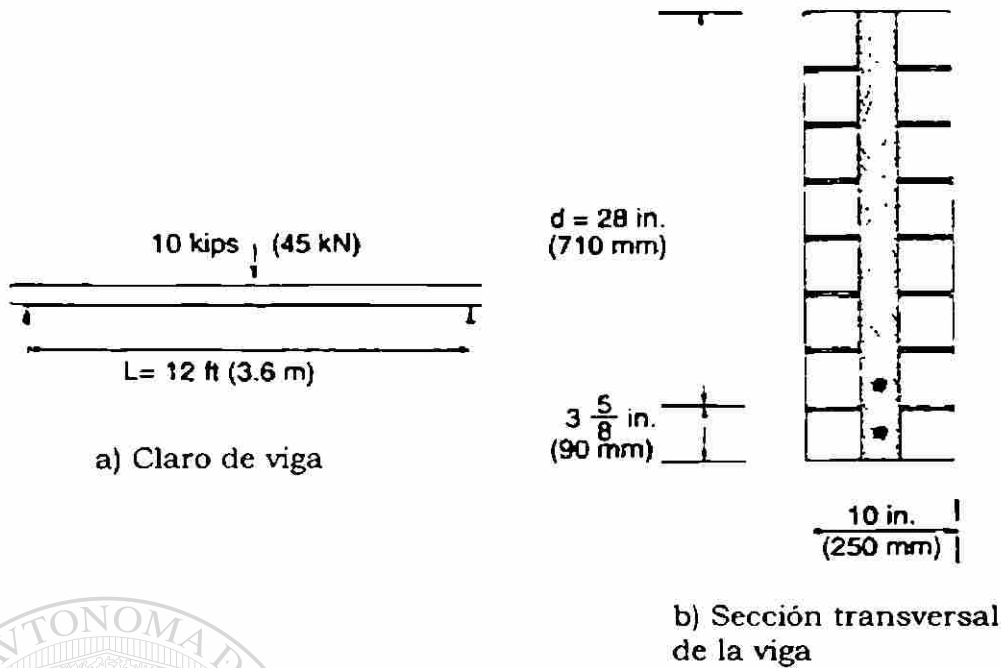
Viga de mampostería de ladrillo del ejemplo 3.1.
